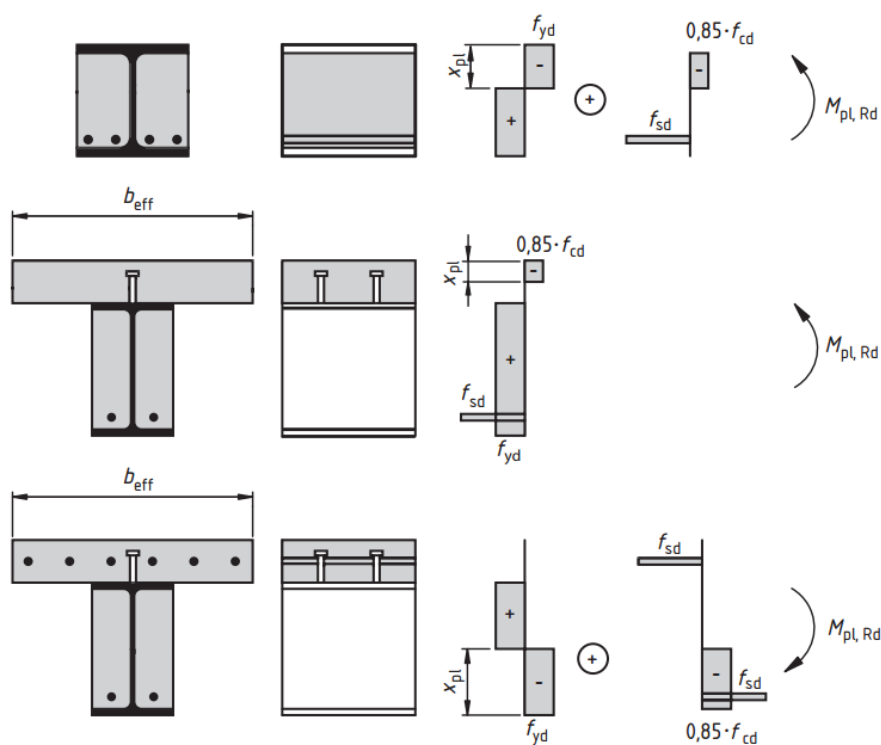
Exemplos de análise de secções transversais de vigas mistas parcialmente revestidas (CEN, 2011).
